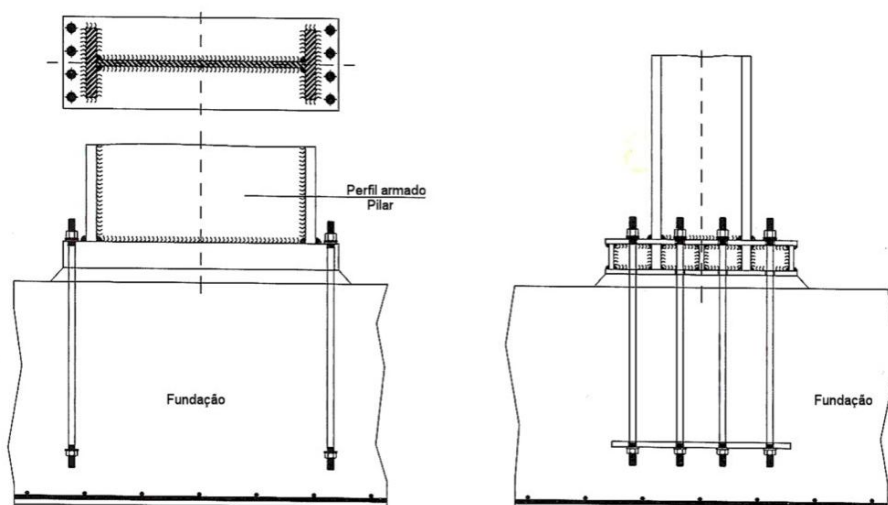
Arranque de pilares metálicos (Eisele; Kloft, 1999)
